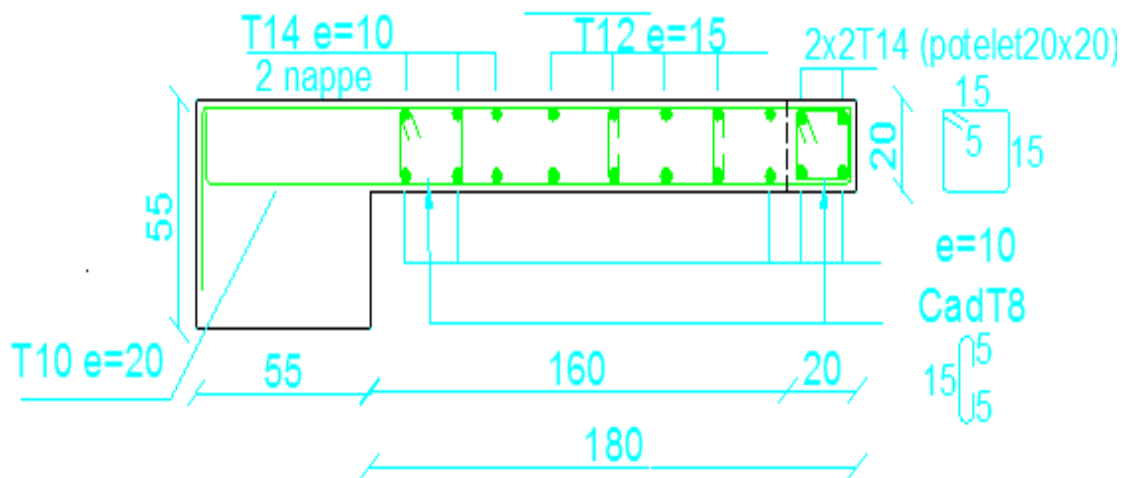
Schéma de ferrailage des voiles type V5 zone 1.
